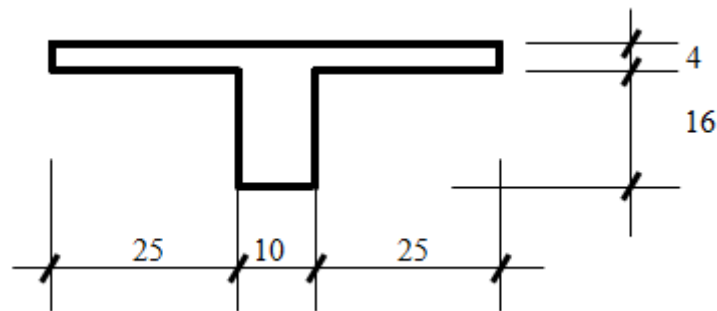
Dimensions finales de la poutrelle d'un plancher corps creux
